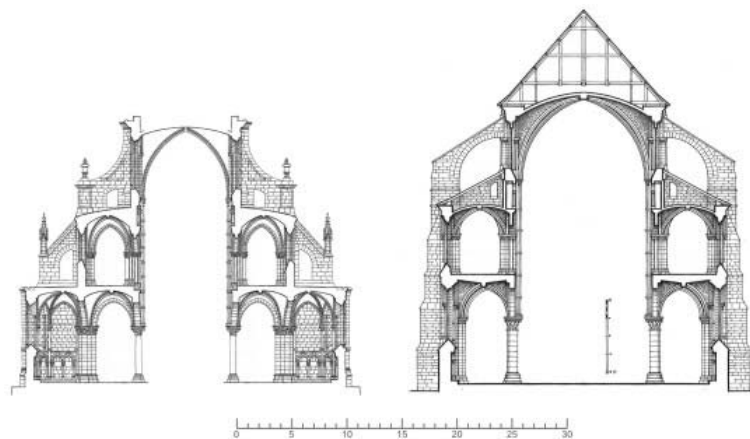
Secciones de las catedrales de Noyon (i.1150) y Laon (i.1162) (Acland)
